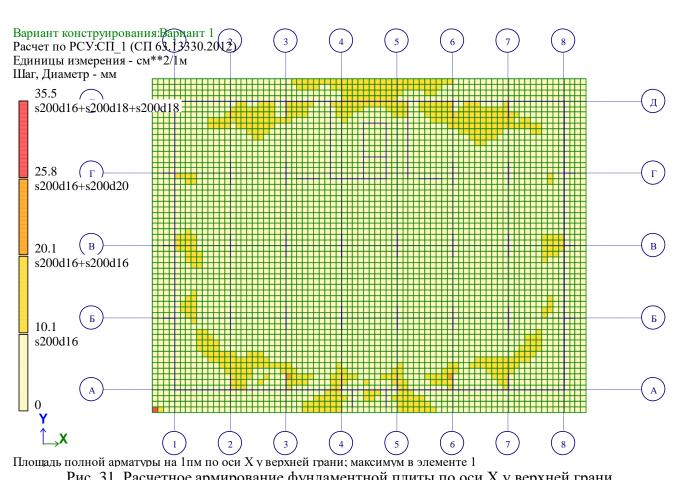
Расчетное армирование фундаментной плиты по оси X у верхней грани.
